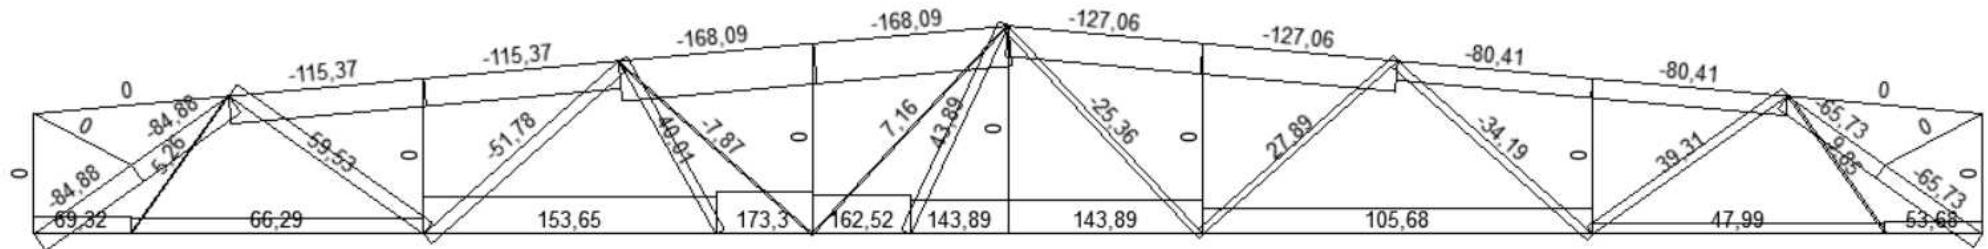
Эпюра внутренних усилий от второй комбинации крановой нагрузки
